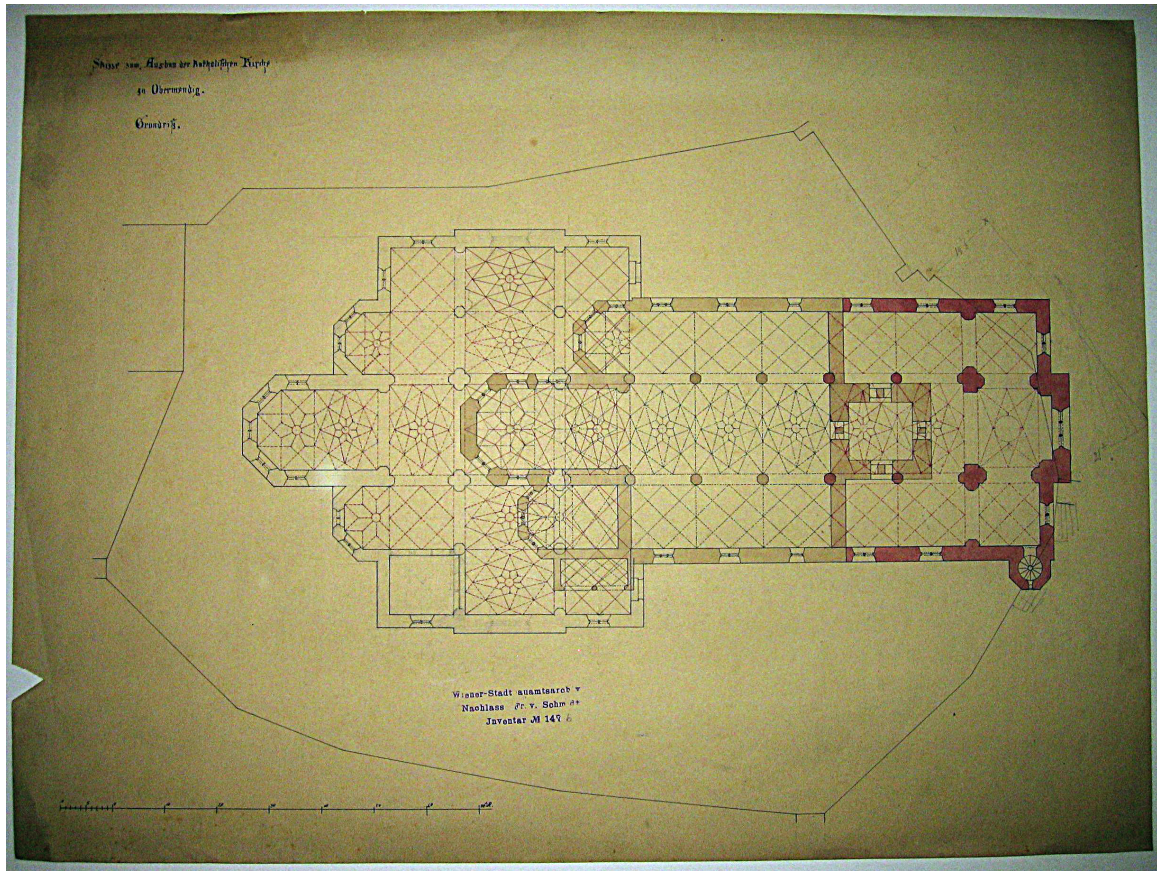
WM, Inv.-Nr. 157.147b/1 Grundriss
